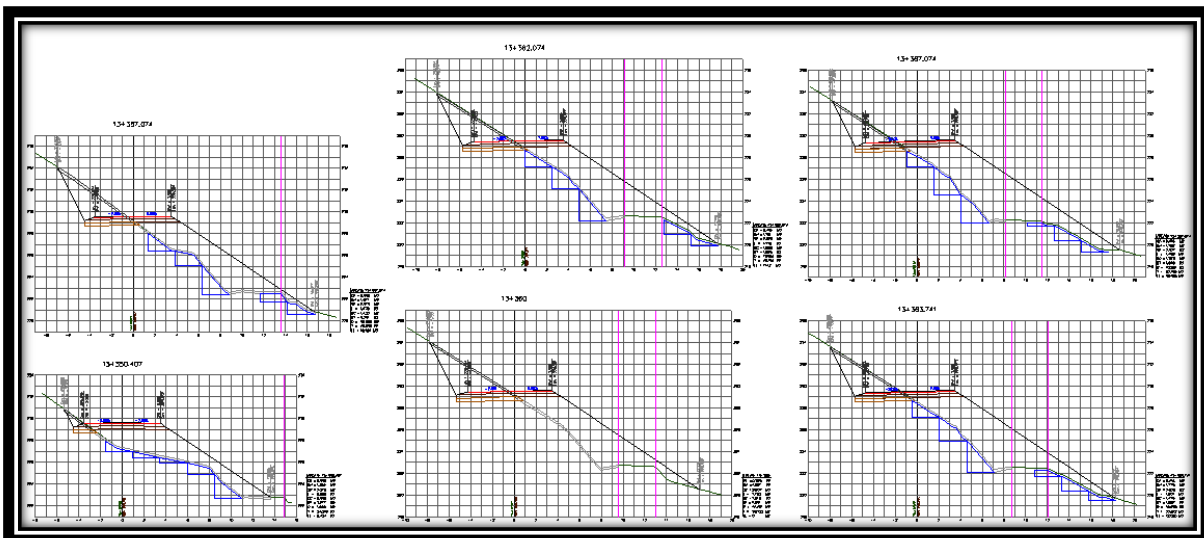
Secciones de construcción del km 13+350.407 al km 13+367.074.
